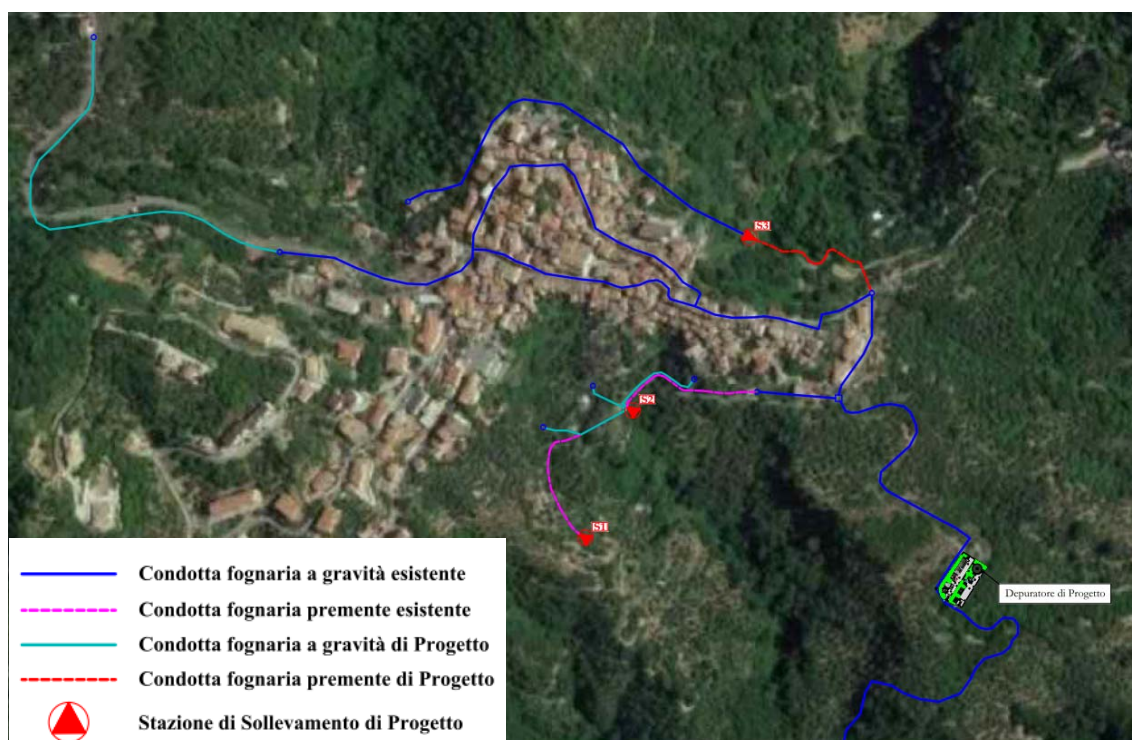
Estratto ortofoto Pentone centro ed ubicazione interventi
